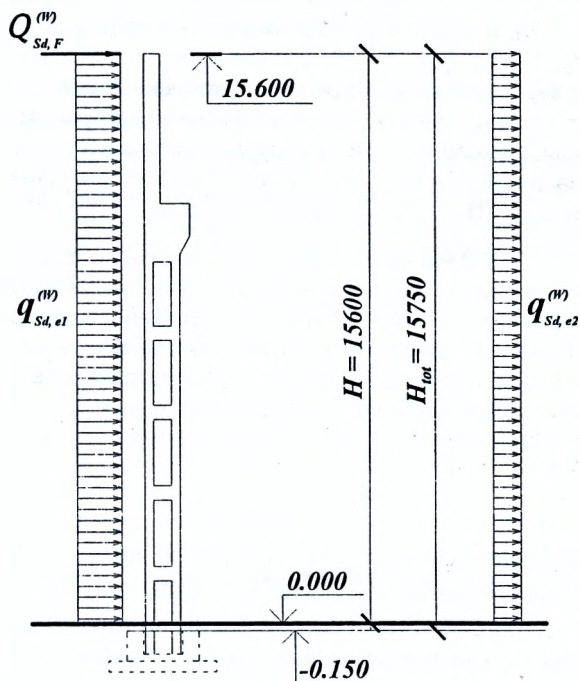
К определению ветровой нагрузки на колонну
